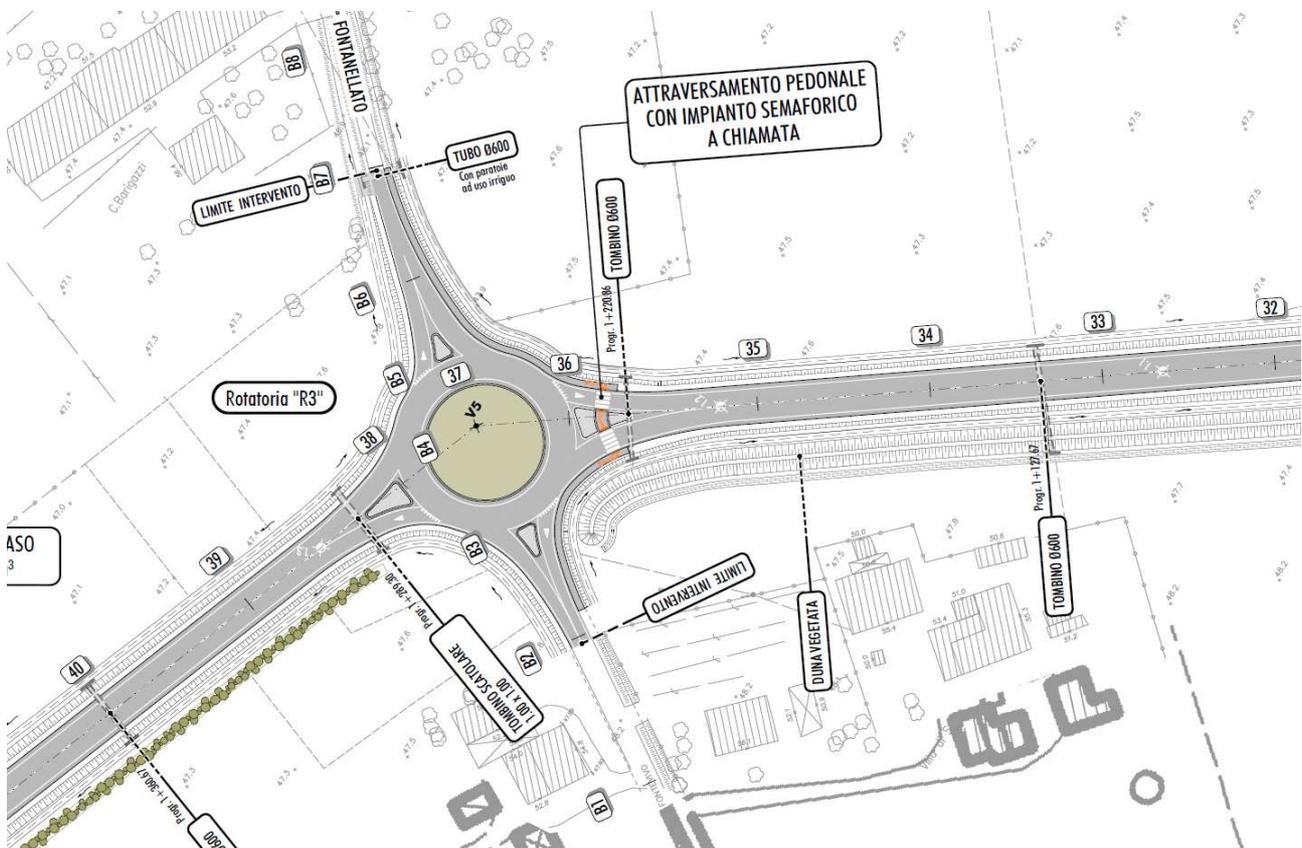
STRALCIO PLANIMETRICO ROTATORIA "R3" STRADA VILLA DI SOTTO LATO EST E LATO OVEST
